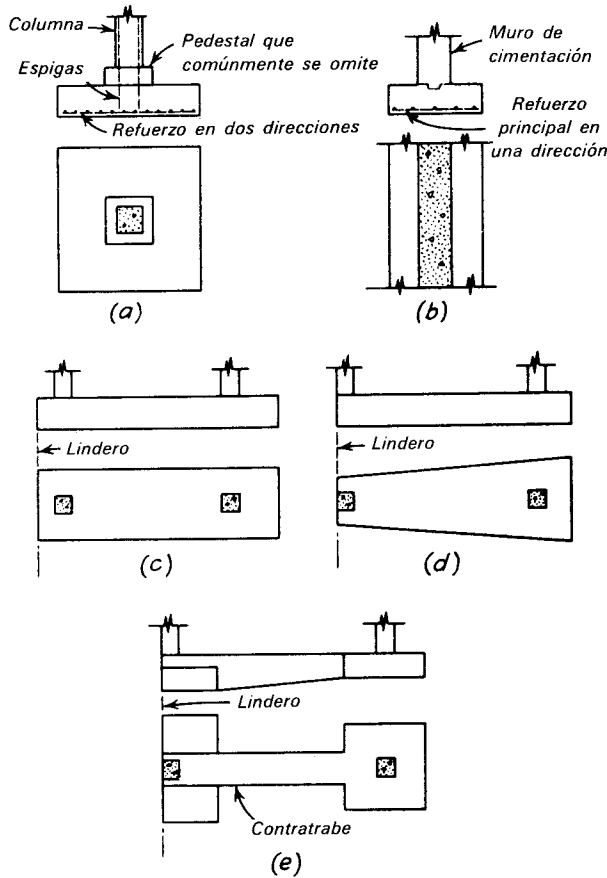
Tipos de zapatas. *a)* Zapata individual para columna. *b)* Zapata para muro. *c)* y *d)* Zapatas combinadas. *e)* Zapata en cantilever.
